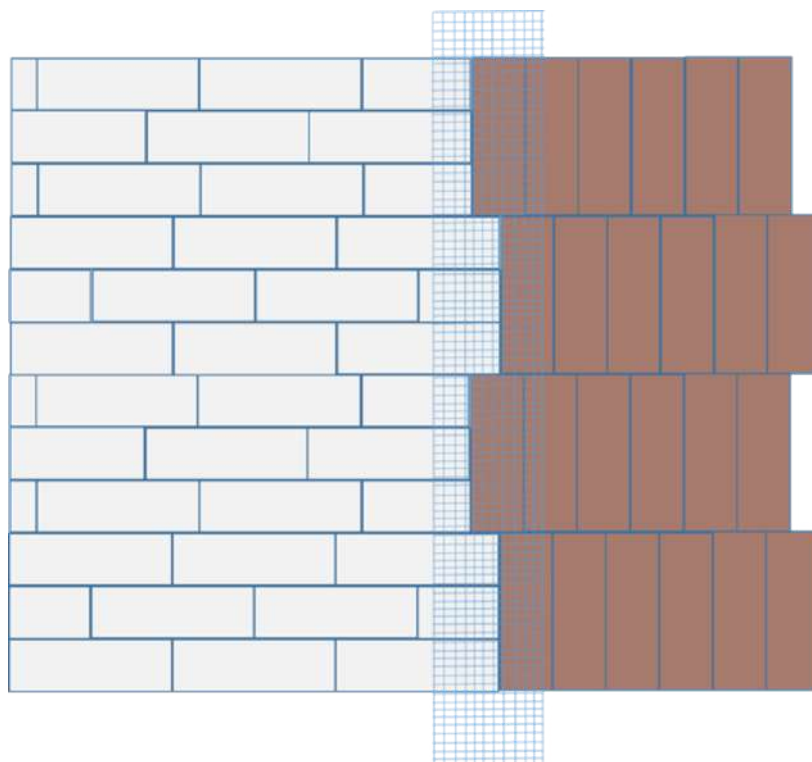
Plan de jonction horizontal-vertical : Revitherm EP PSE 1,2 m x 0,6 m / Revitherm EP BOIS (isolant STEICO) 1,2 m x 0,4 m
